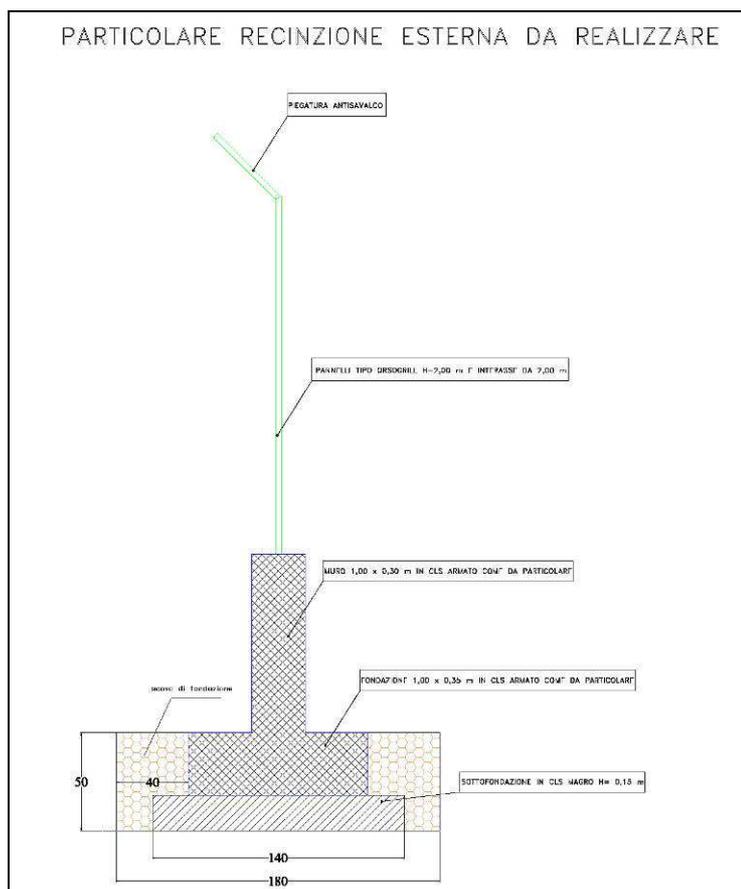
Particolare costruttivo della recinzione perimetrale all'area portuale
